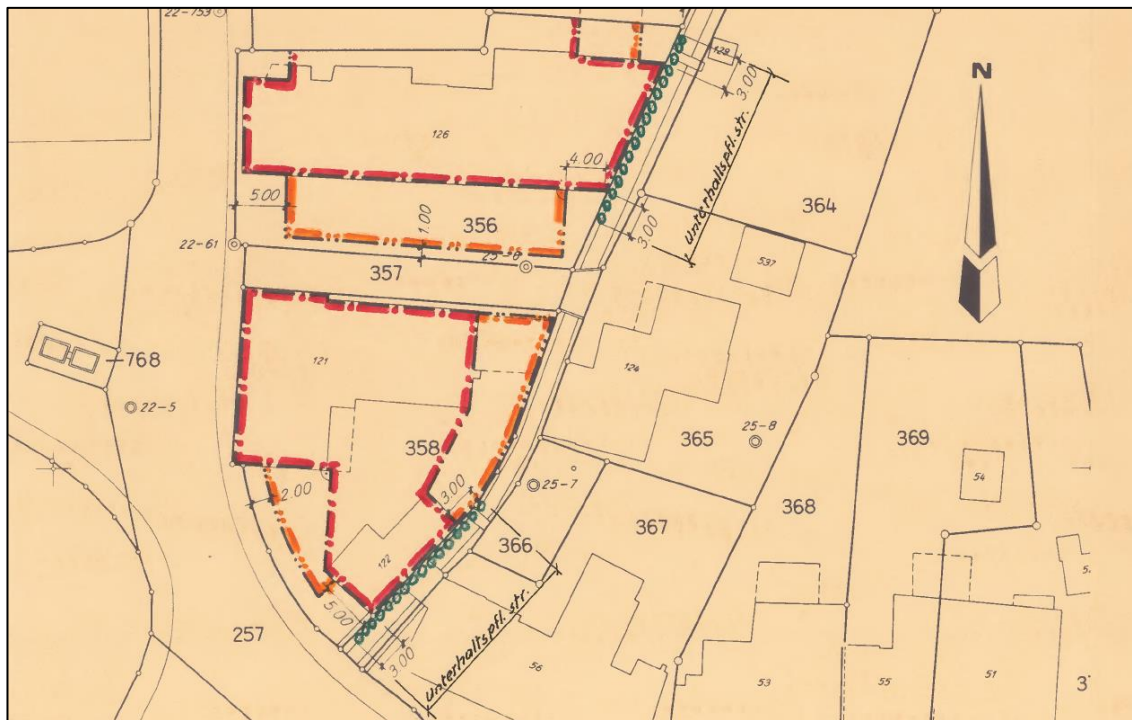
Ausschnitt Baulinienplan Lamm (1989). Quelle: www.map.geo.tg.ch, 25.08.2022.
